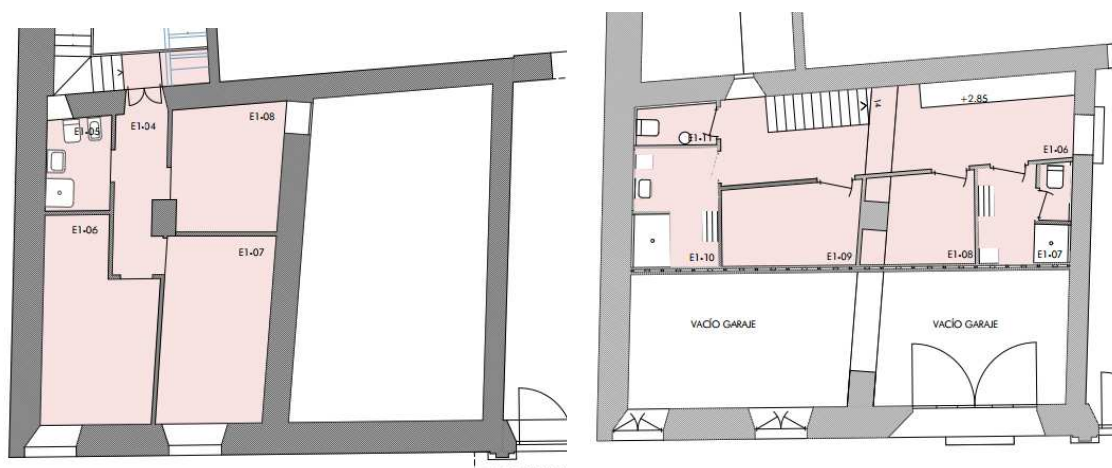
Entreplanta. Estado previo (izquierda) y estado reformado (derecha)
